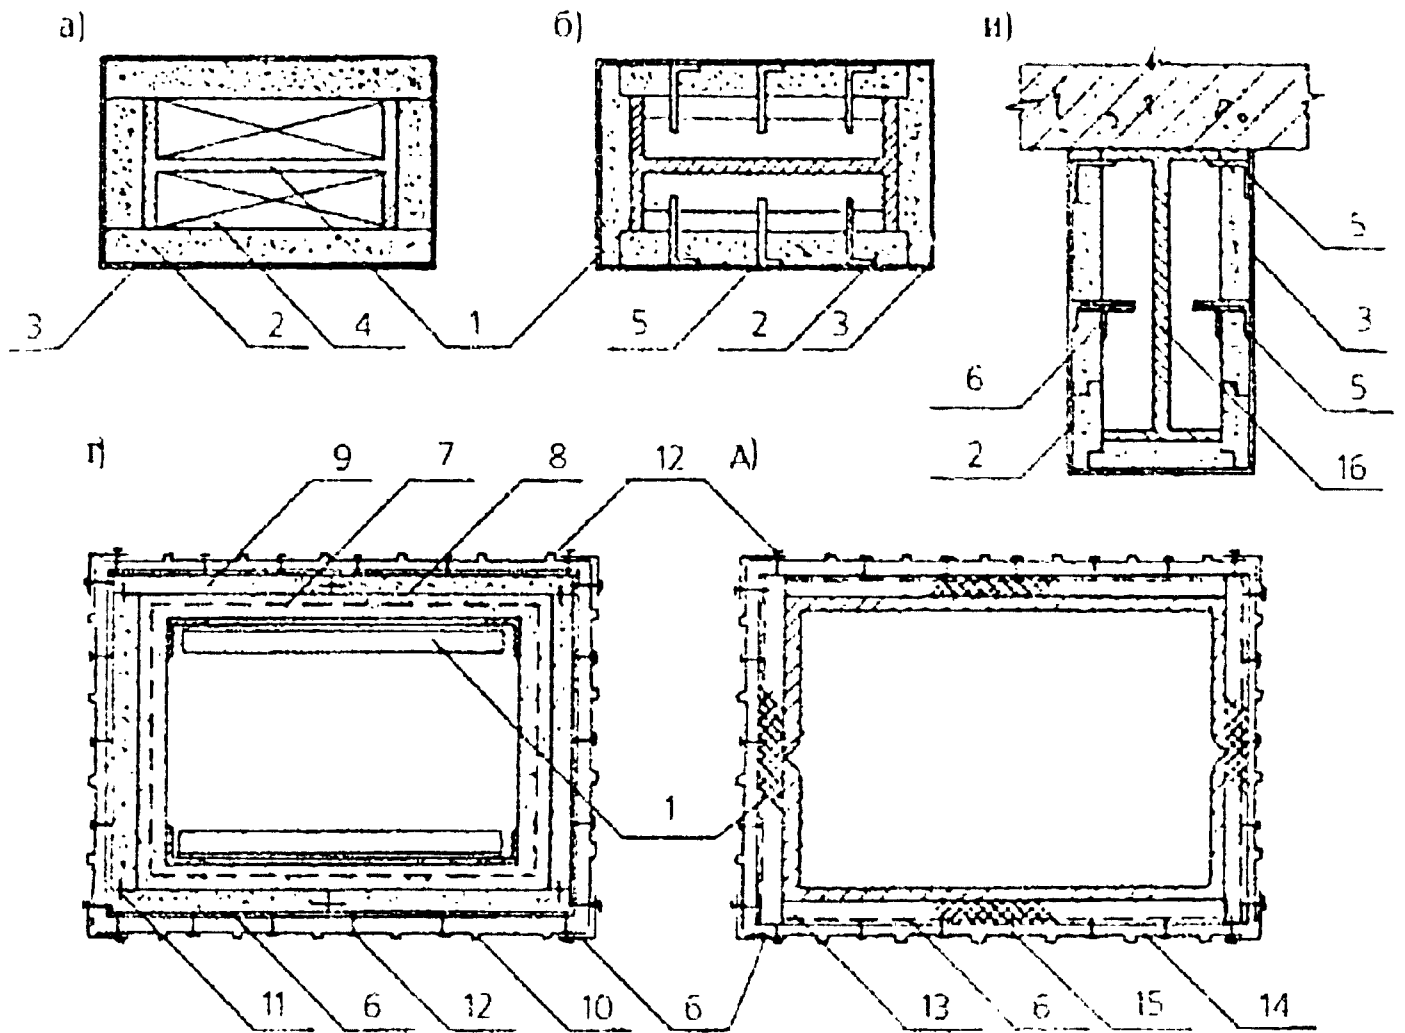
Облицовка металлических конструкций теплоизоляционными плитами:
